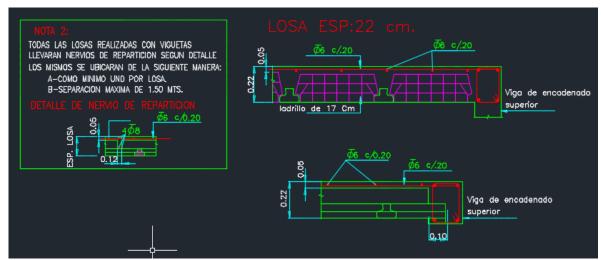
Detalles de losas de viguetas pretensadas – proyecto parque este
